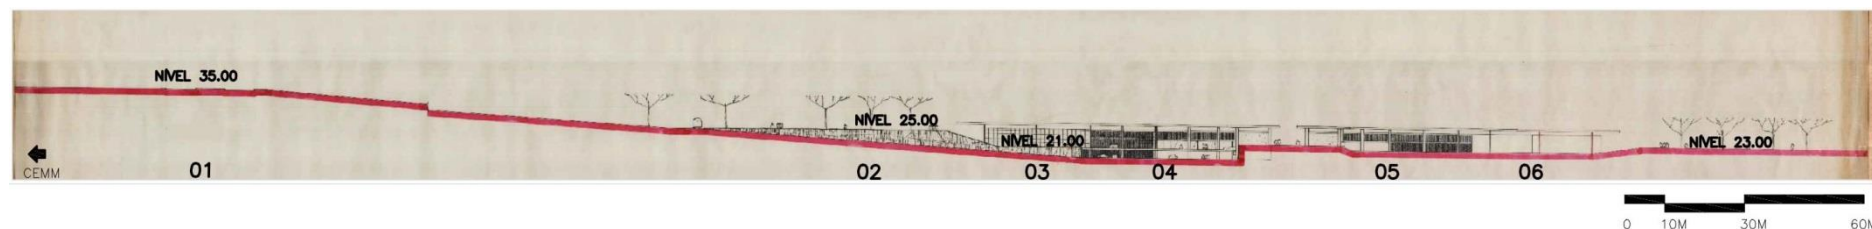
Elevação Leste Plano UMA. Fonte: Pranchas 09 e 10 do Plano de Implantação Imediata – 1º Sub-Etapa Plano UMA – Arquivo digital disponível no COMCAP-UEM.
